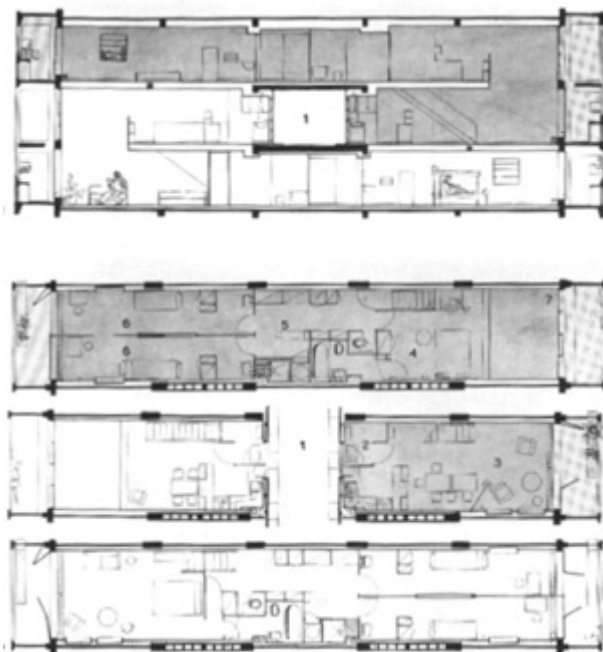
Esquema de la planta y sección de los departamentos dúplex.
